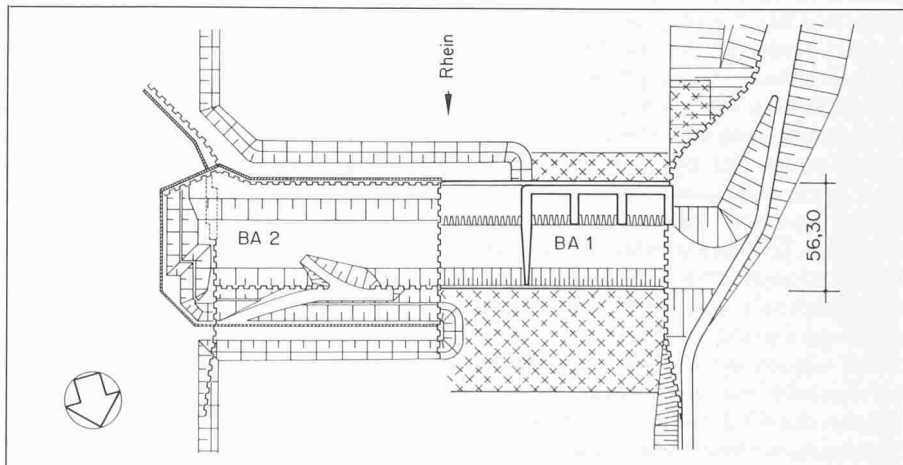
Lageplan mit Baugrube, 2. Bauabschnitt
